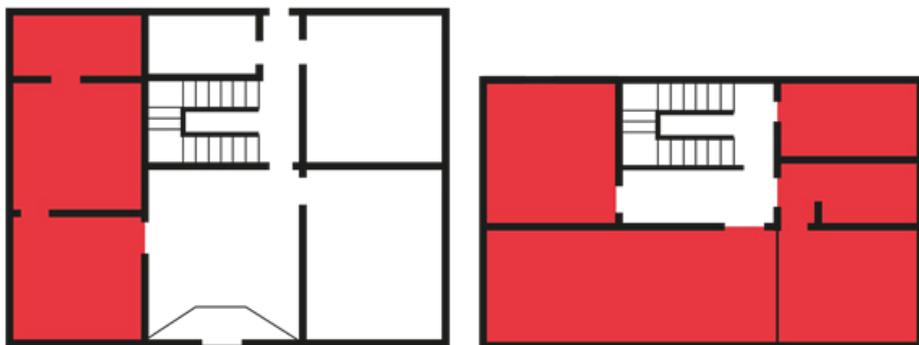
Esquema das planta térrea e da planta do primeiro pavimento com demarcação das áreas de exposição do museu. Fonte: Autor, 2021.
